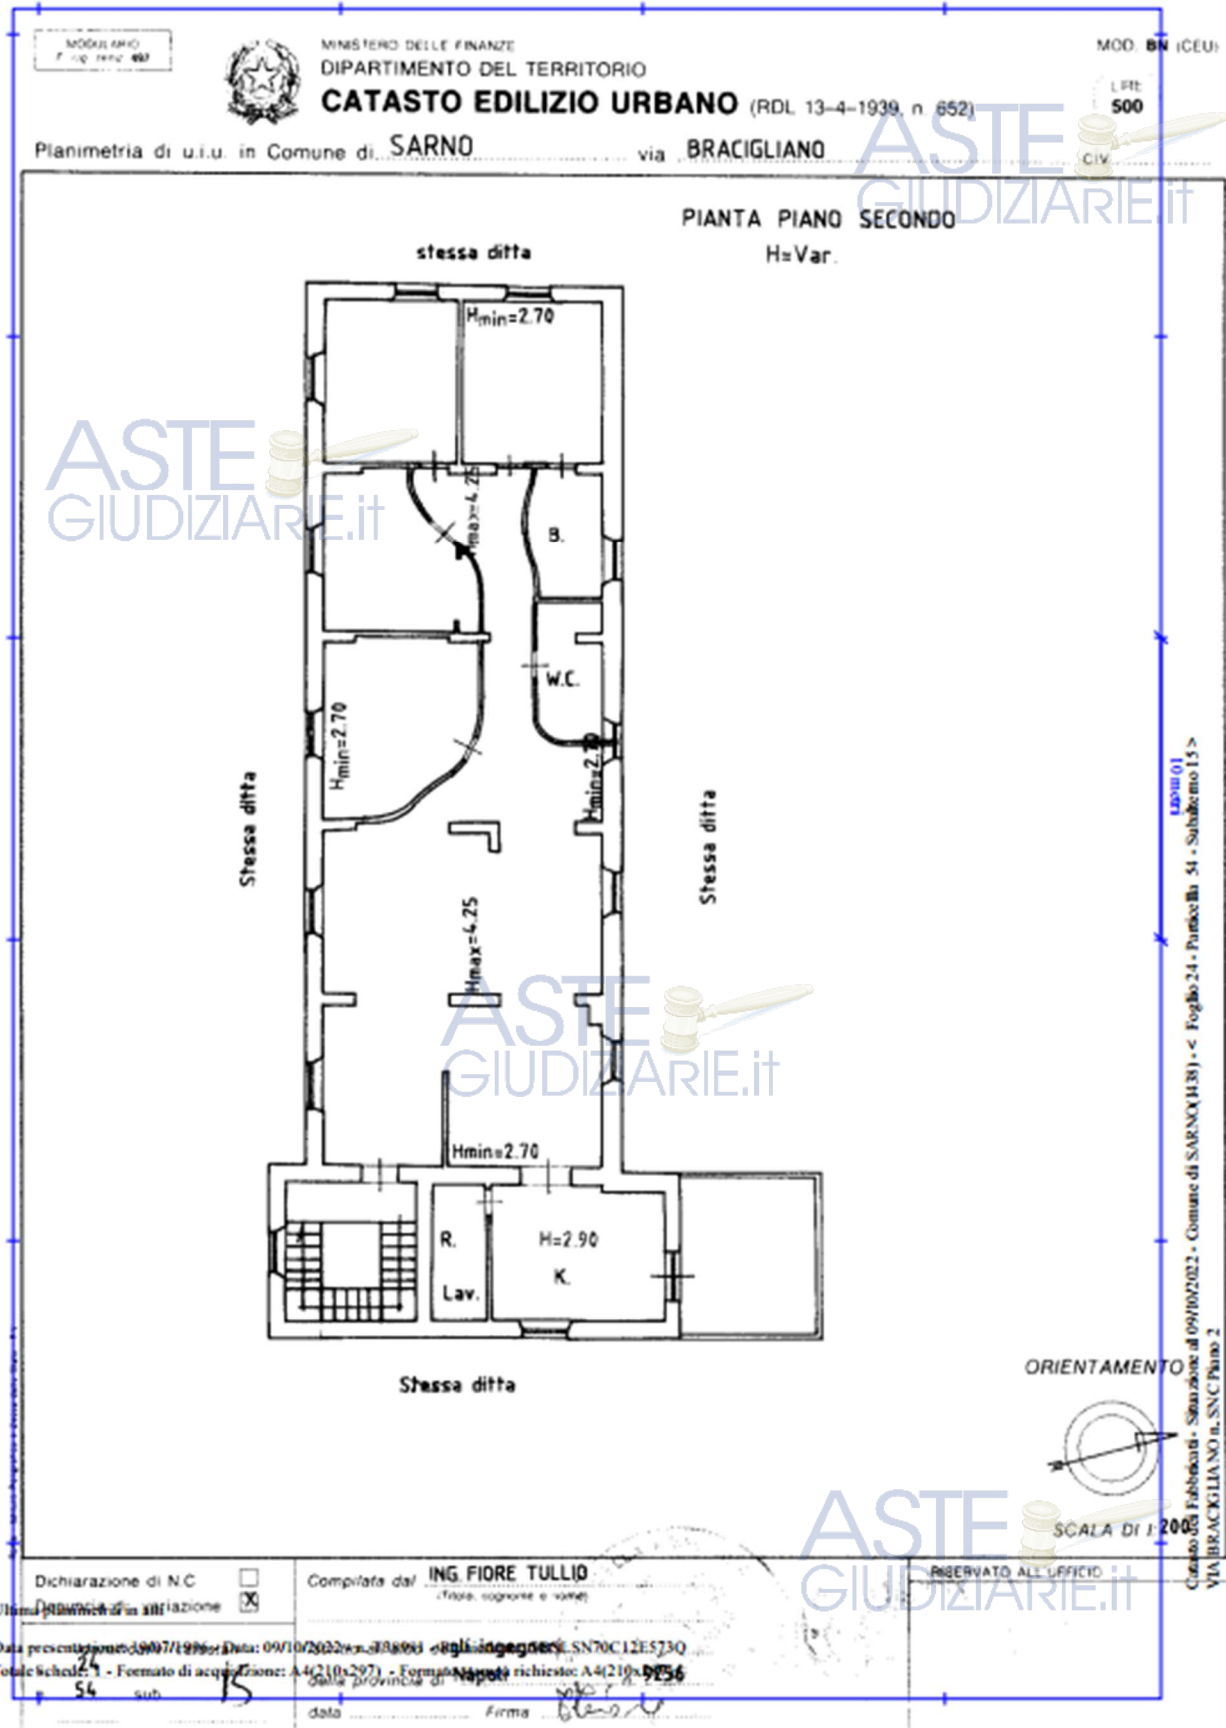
Planimetria catastale appartamento lotto 4 (F. 24 p.la 54 sub 15)
